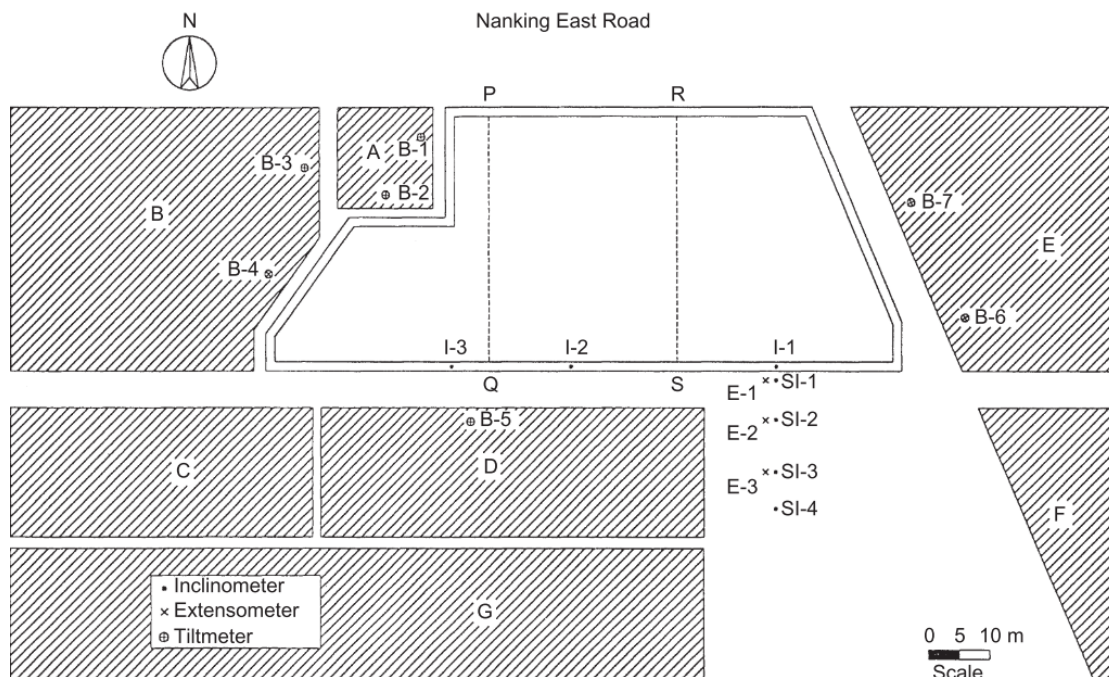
Planta de instrumentação do TNEC (Ou et al., 2000)
